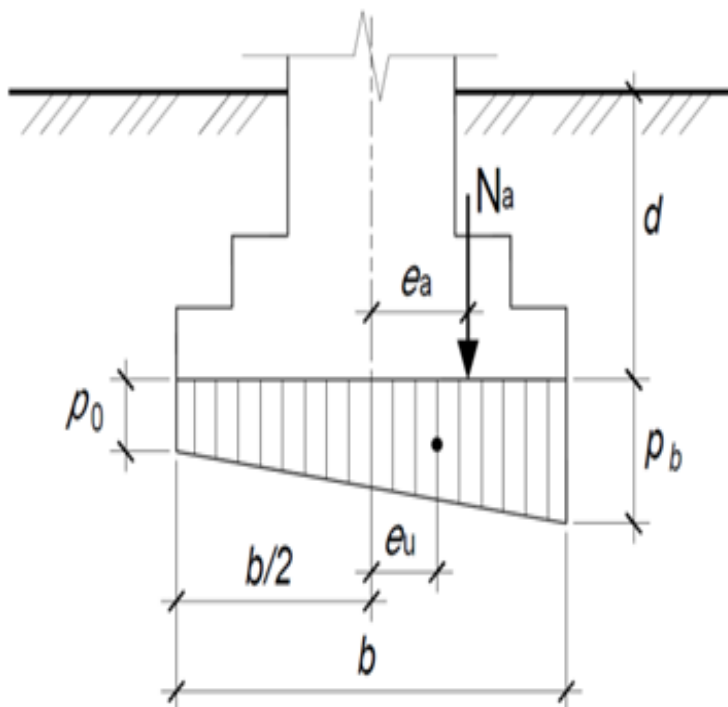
Эпюра предельного давления под подошвой фундамента при сейсмическом воздействии.
